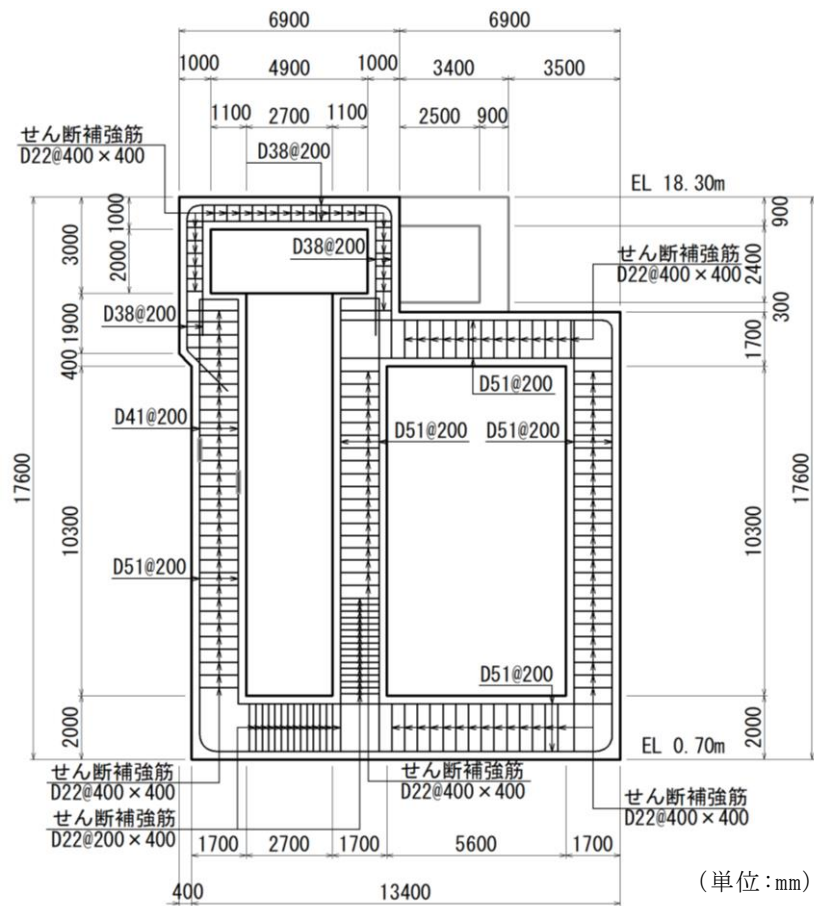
第 1 ベントフィルタ格納槽概略配筋図 (E-E 断面)
